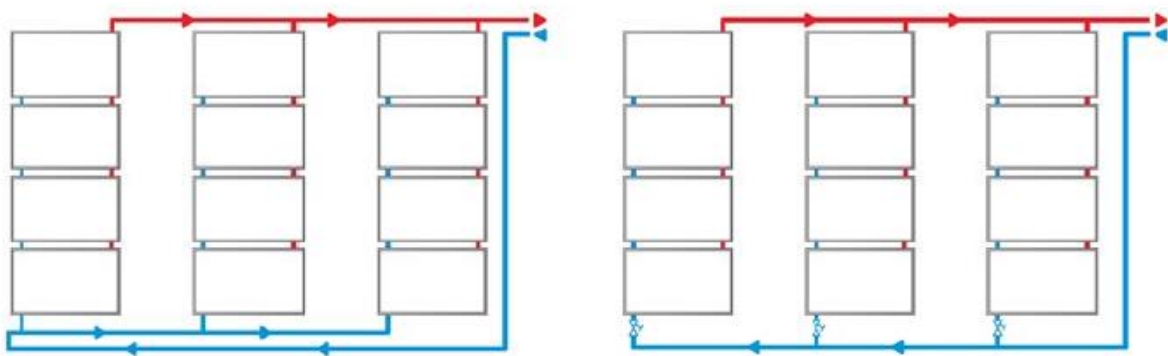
Baterías de captadores conectados con ramal de ida invertido y con válvulas de equilibrado.
